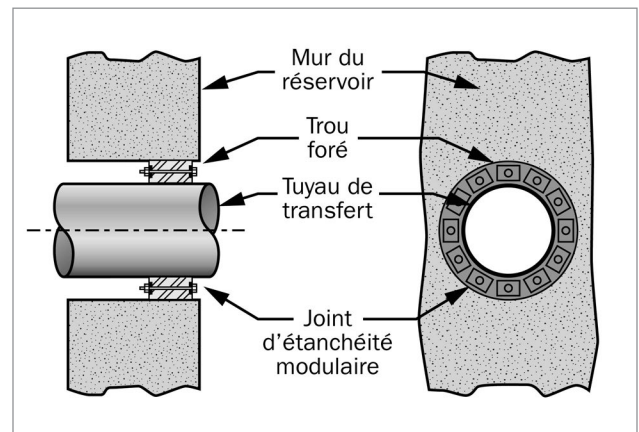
Croquis d'un joint d'étanchéité modulaire.
